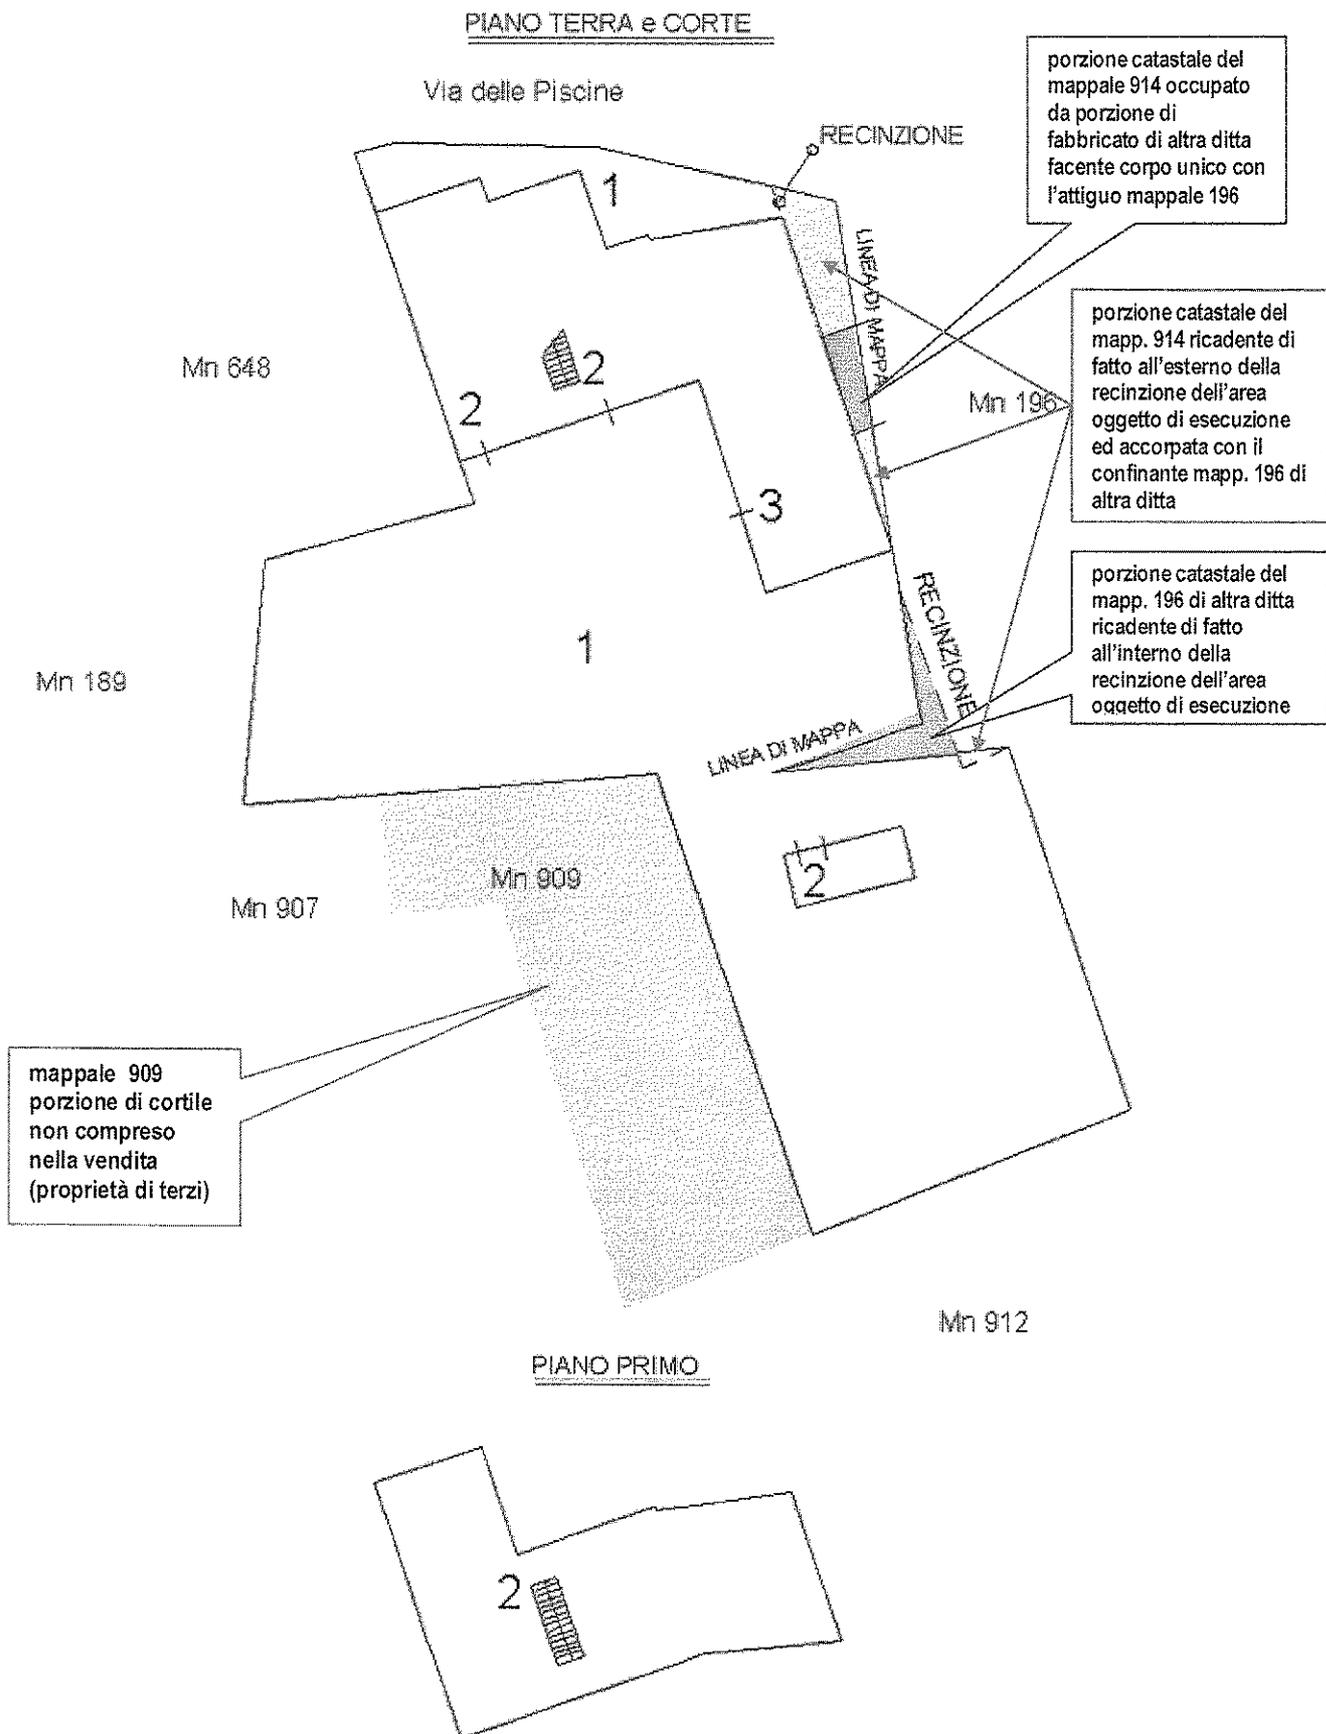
elaborato planimetrico, sez. D – fg. 4 di Montebelluna, mappale 914 (fuori scala)
